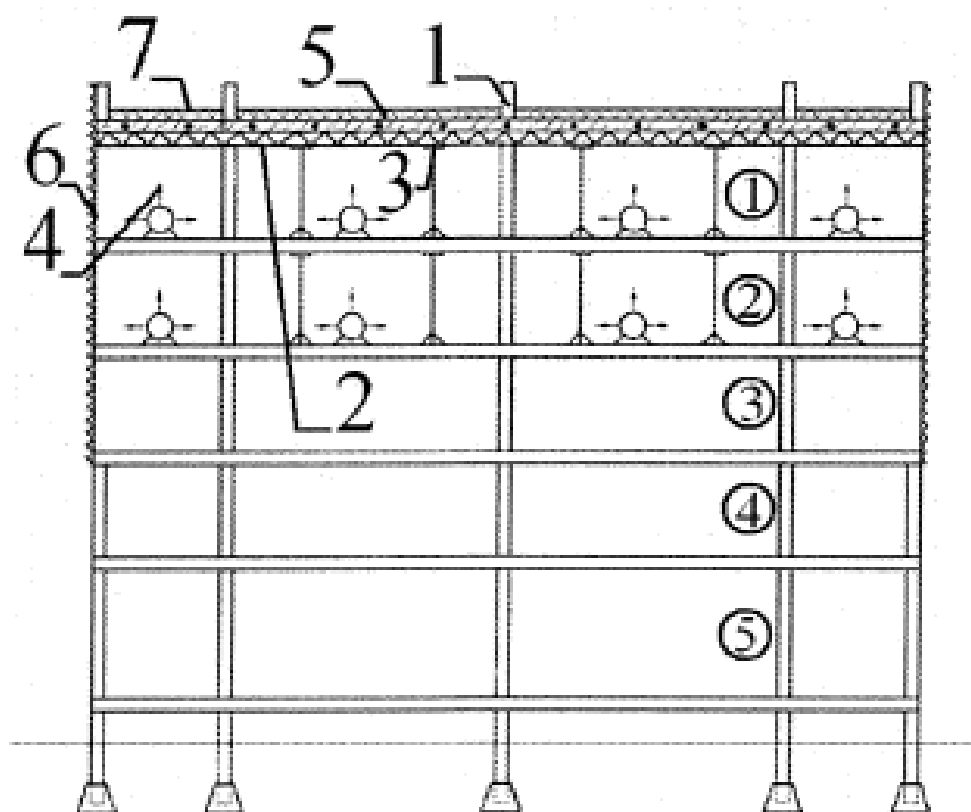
Поярусная термообработка бетона в туннельной опалубке и выдерживание конструктива до набора критической прочности: 1 – монолитные конструкции; 2 – туннельная опалубка; 3 – стойки, поддерживающие опалубку потолка (плиты перекрытия); 4 – теплотворные установки (калориферы, парогенераторы); 5 – ячейки (туннели) опалубки; 6 – светопрозрачные щиты; 7 – утеплитель.
